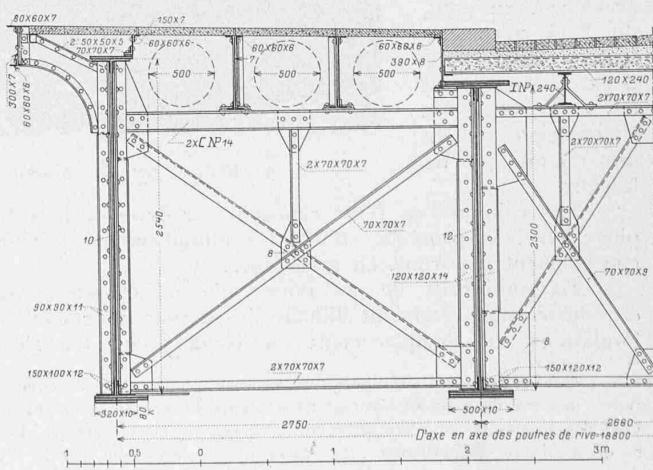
Coupe transversale sur piles. — Echelle 1:50.
